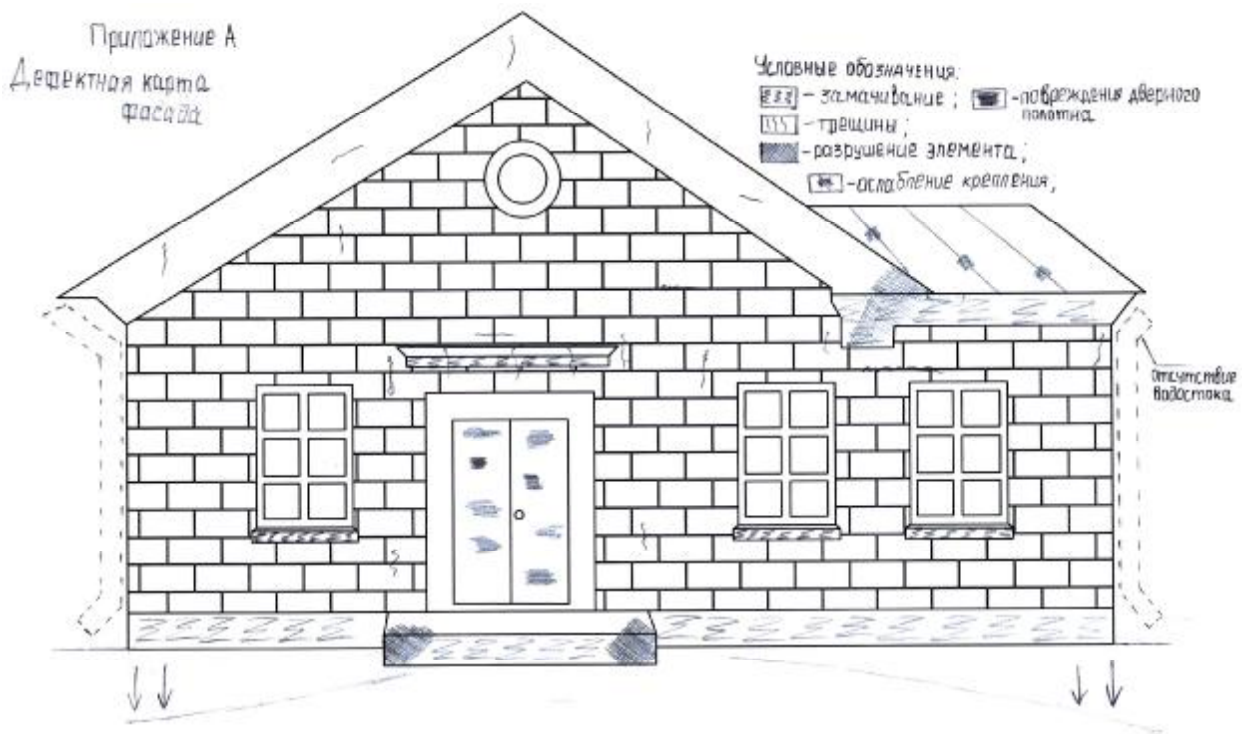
Дефектная карта фасада кирпичного здания.
